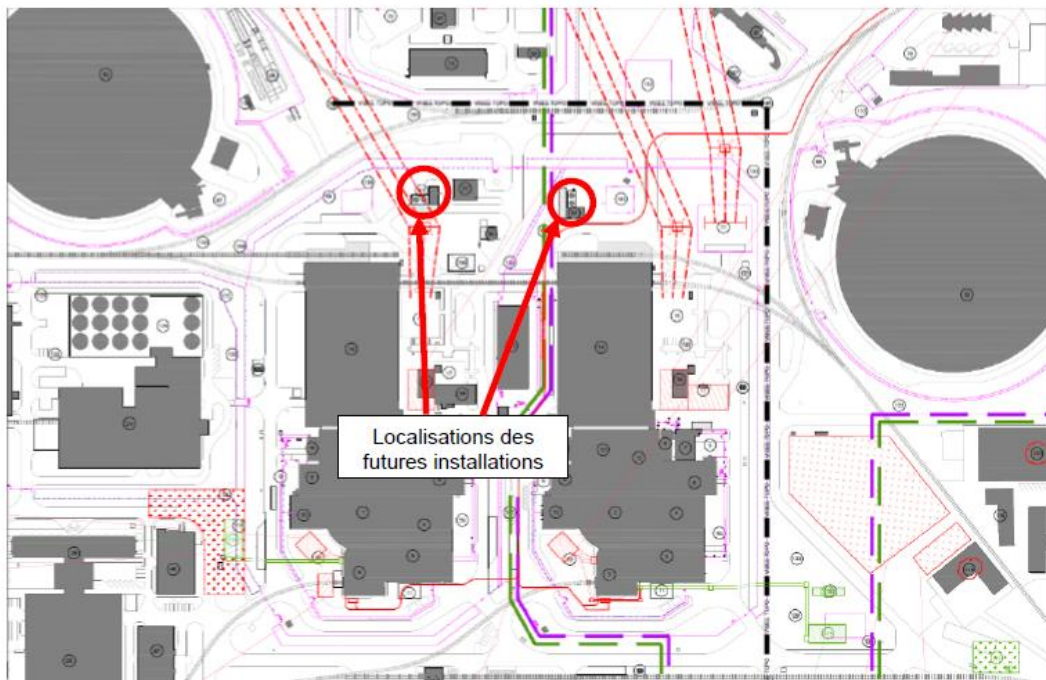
Plan de localisation des installations CTE du CNPE de Civaux
